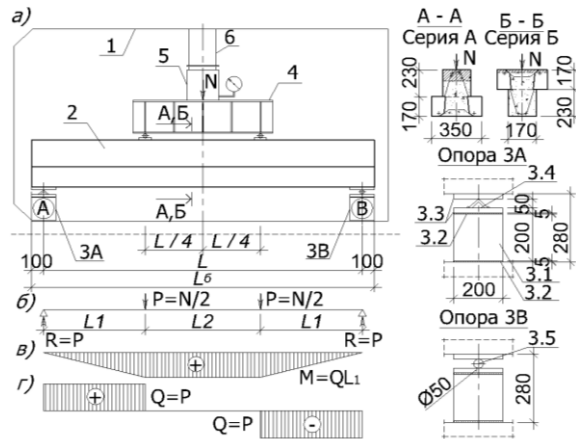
Схема испытания СбМт балок серий А и В внутренних стен (а), расчетная схема (б) и эпюры M, Q (в, г), без учета собственного веса: 1 - рама испытательного стенда; 2 - СбМт балка; 3А - опора неподвижная; 3В - подвижная опора; 4 - траверса на подвижных опорах; 5 - гидравлический домкрат $N=300$ кН (30 тс). [Разработка автора].
